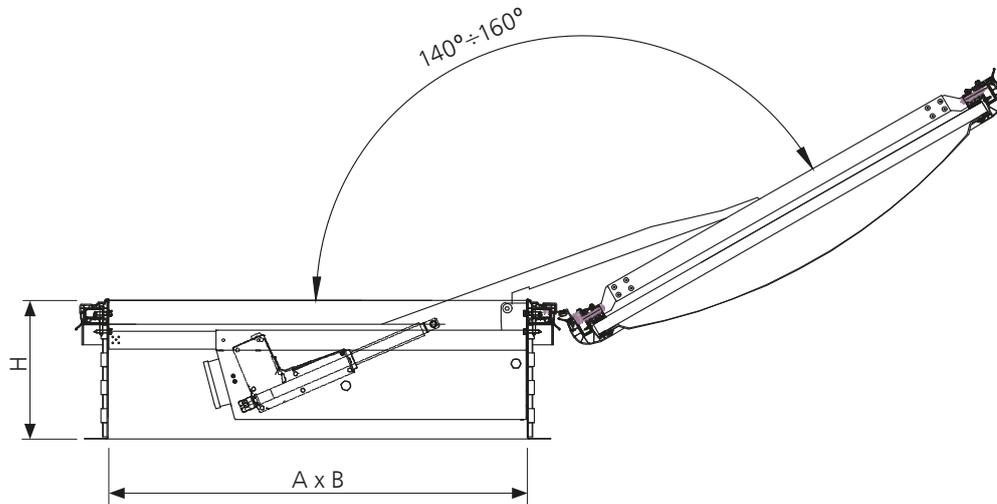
Schnitt B-B durch ein RWA-Gerät mcr ULTRA THERM Typ E mit geradem Stahlaufsatzkranz in Dachausstiegsausführung in geöffneter Position
